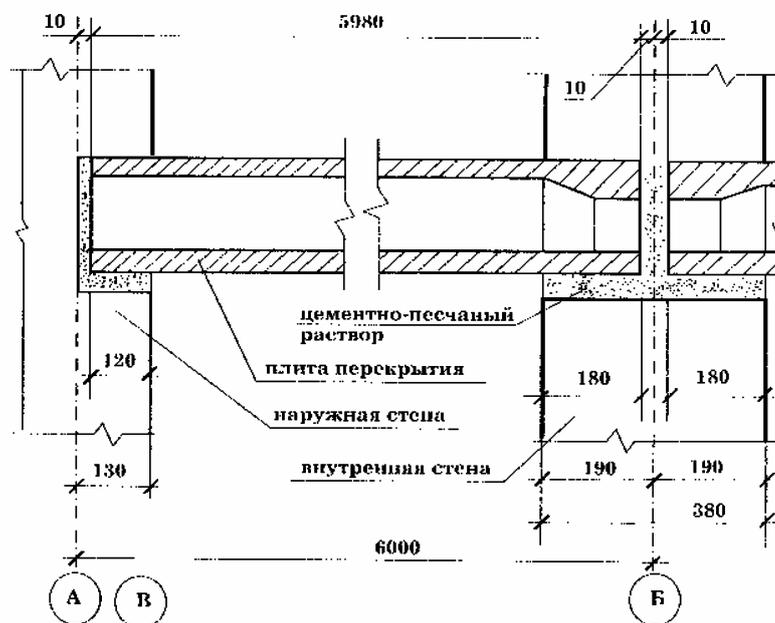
Привязка плит перекрытий к несущим стенам
